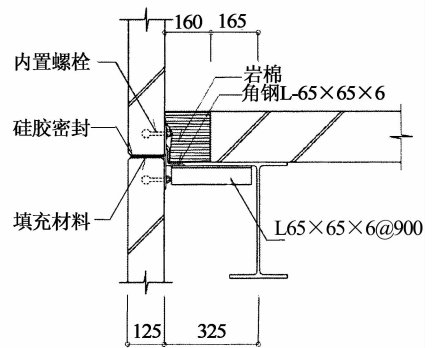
蒸压轻质加气混凝土外挂墙板连接构造
